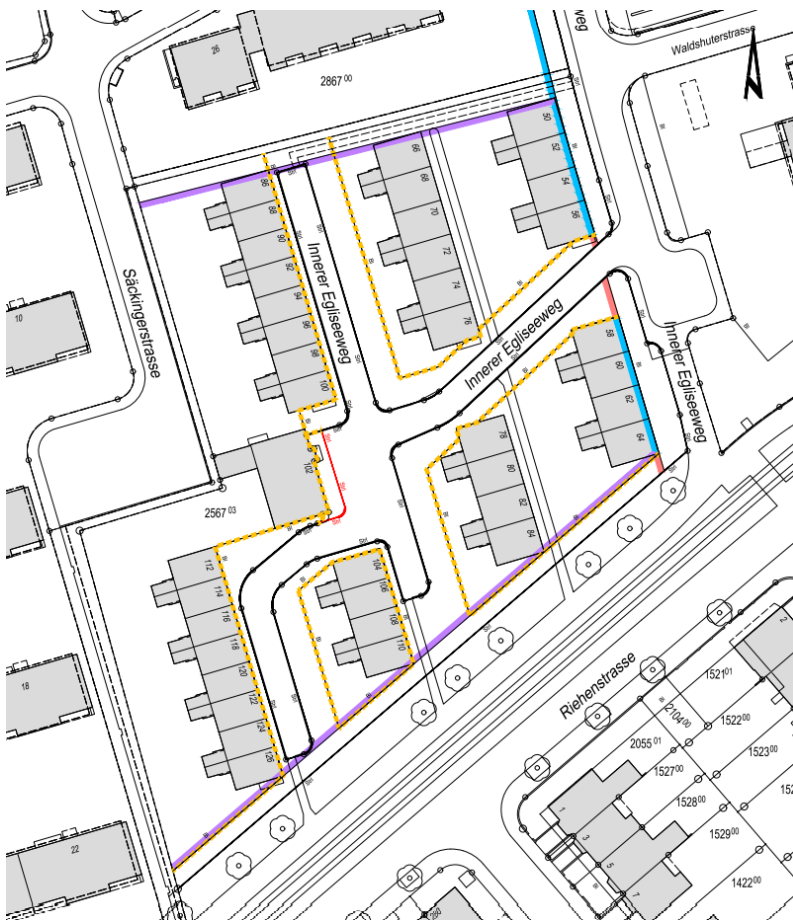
Änderungsplan Bau- und Strassenlinien, Baugrenzen
